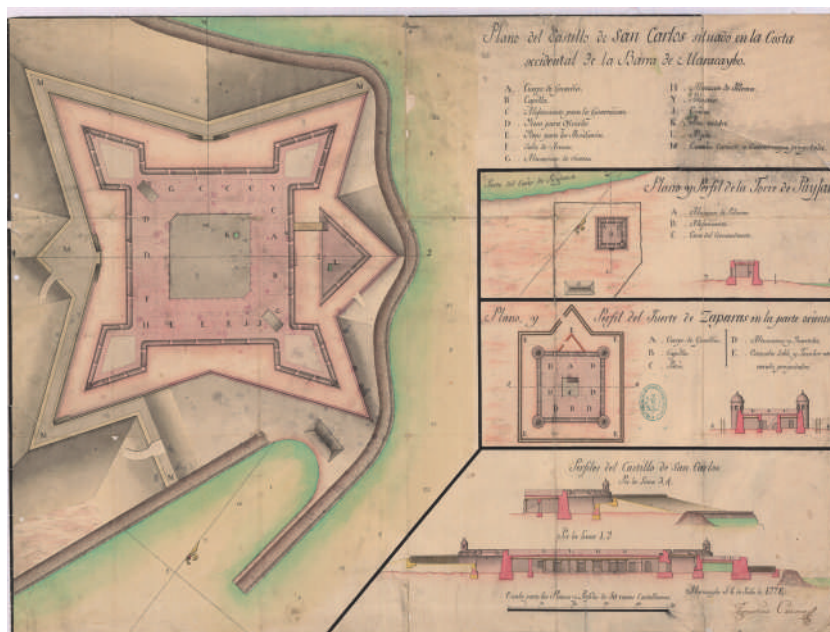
Planta de las fortificaciones de Paijana y Zaparas (Crame, Agustín. 1778. «Plano del Castillo de San Carlos situado en la costa occidental de la Barra de Maracaybo». Maracaibo, 6 de julio de 1778. En AGMM, sign. VEN-9-4)
